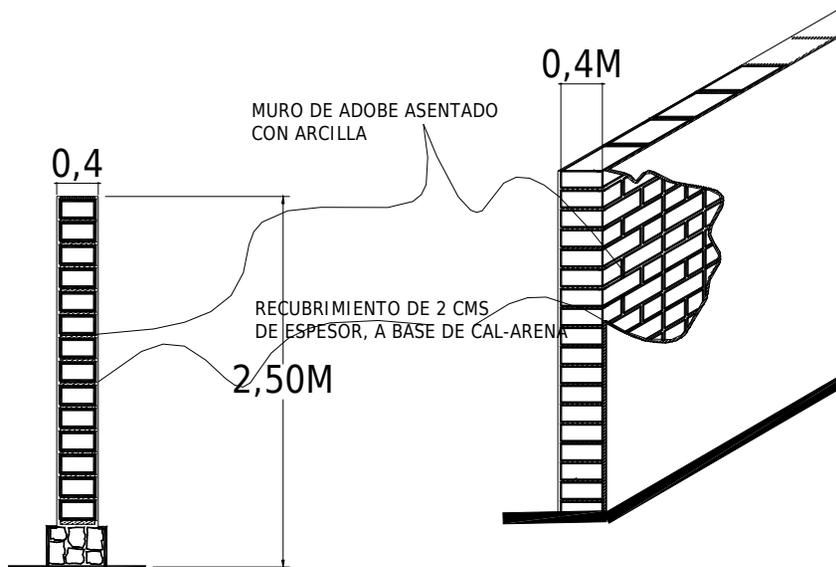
DETALLE DE MUROS DE LA VIVIENDA TIPO.
